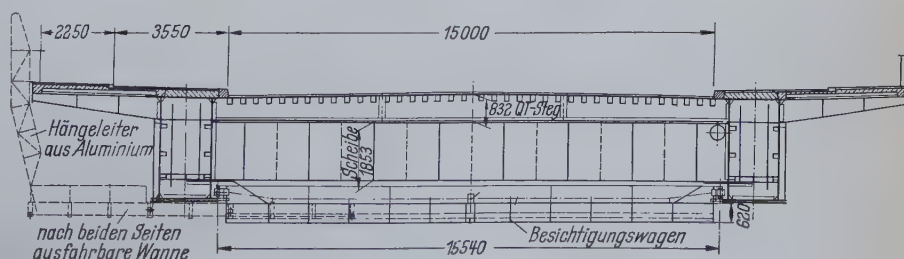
Brückenquerschnitt mit Besichtigungswagen
